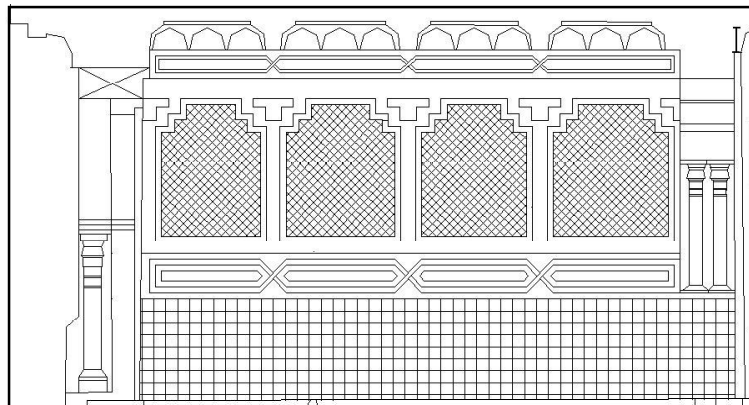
Coupe sur le hall de l'immeuble n°101 boulevard Mohamed V, montrant le revêtement mural.
